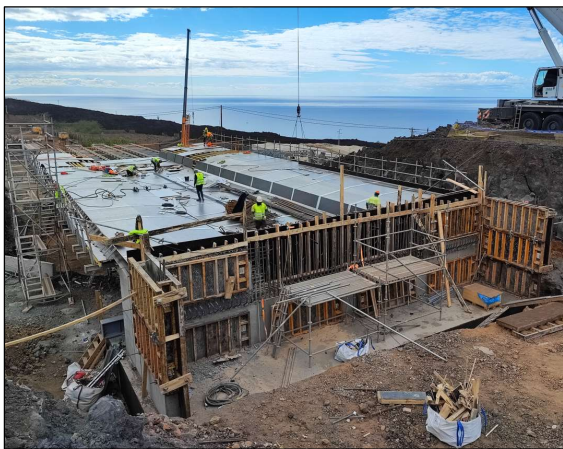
Vista del estribo 1 y primera fase de tablero de cimbra y encofrado.
